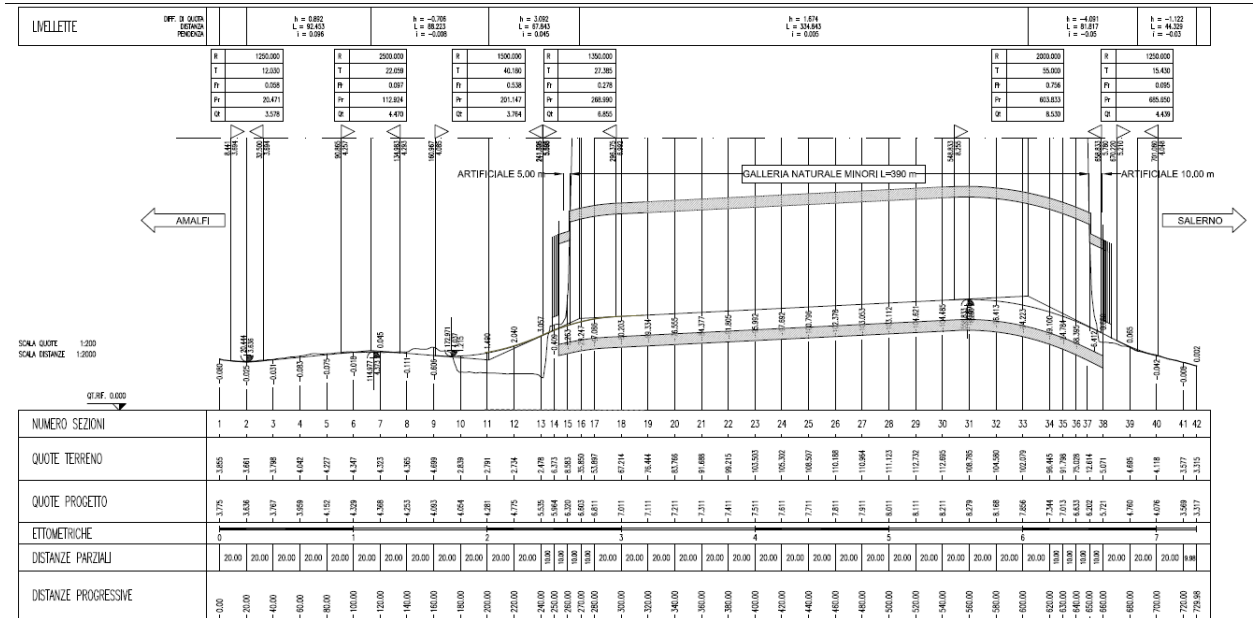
Stralcio altimetrico del tracciato di progetto - T00PS00TRAPP01A
